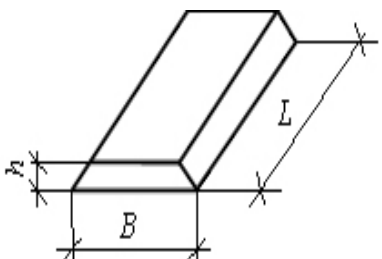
Ребристая плита для сборных ленточных фундаментов 16-этажных зданий
